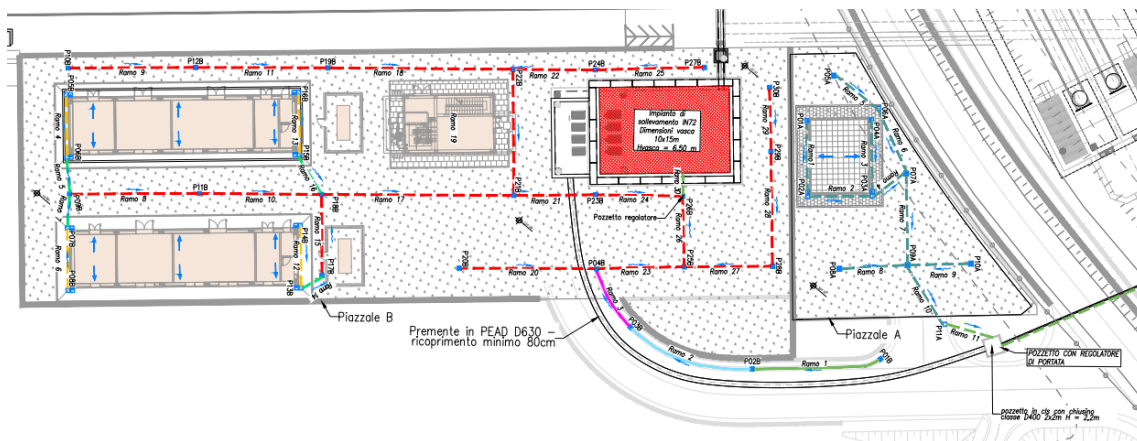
Planimetrica di progetto FA05/A e FA05/B
